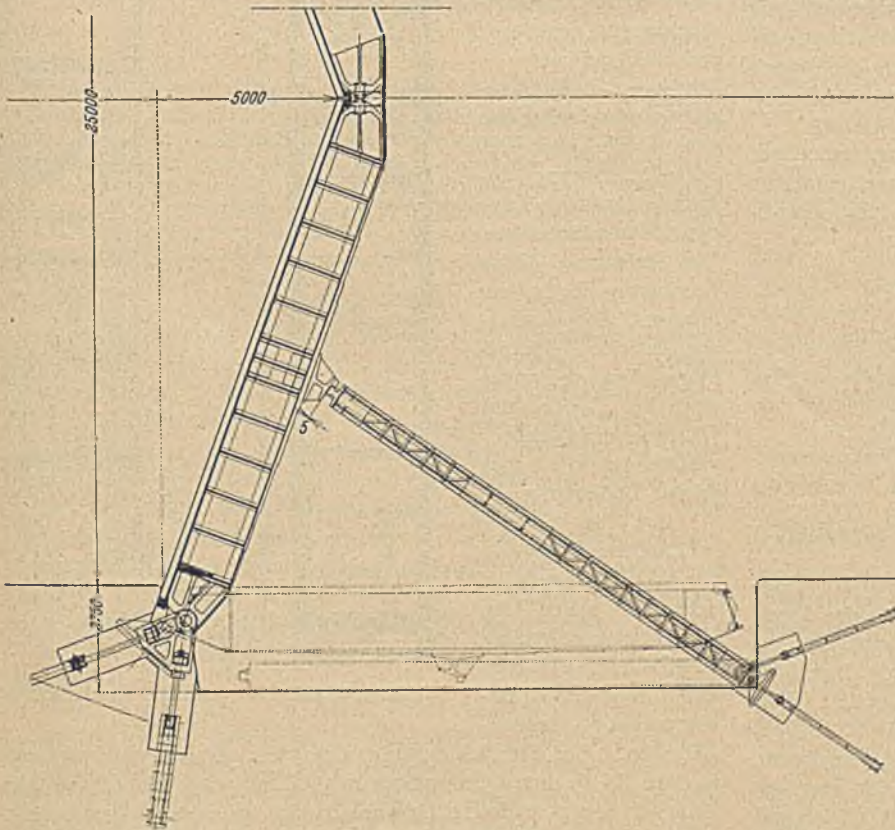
Stau- und Gegentore nebst Verankerung, Grundriß.
